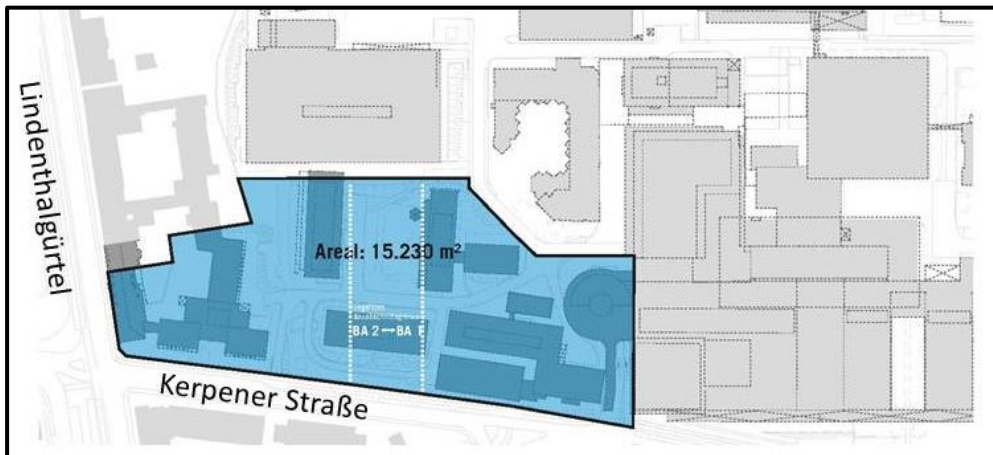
Lageplan Baufeld-West (Quelle medfacilities)
